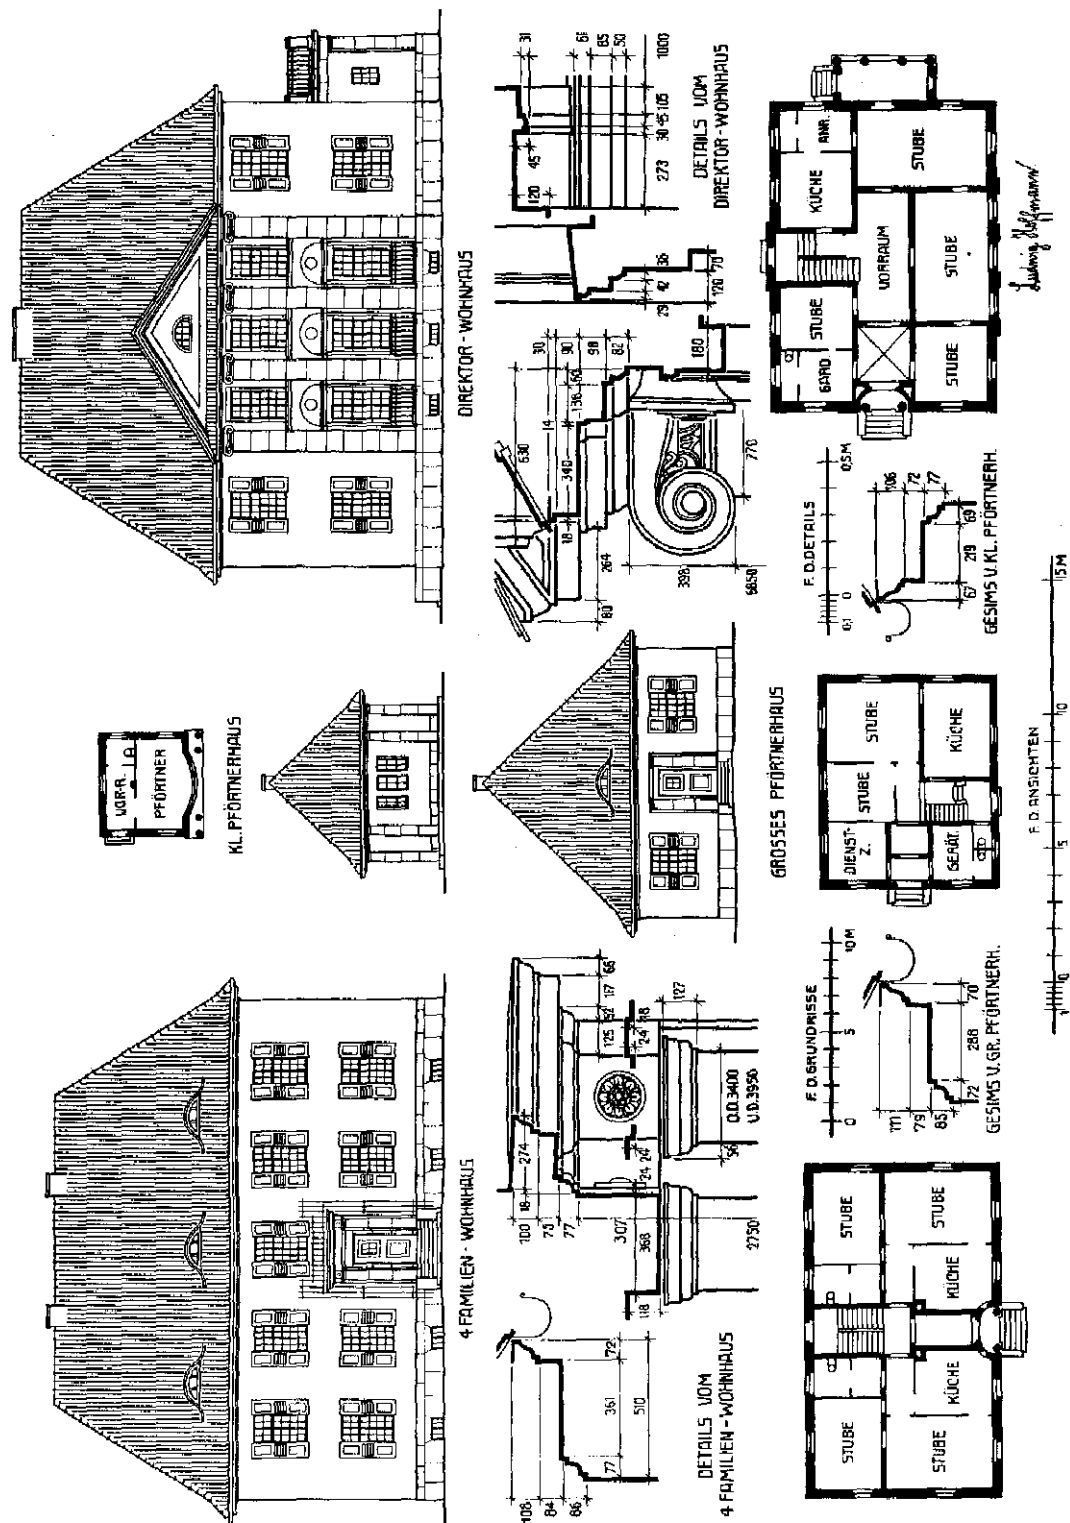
Direktorhaus. Wohnhaus für 4 Familien und 2 Pförtnerhäuschen. Ansichten, Grundrisse und Details
